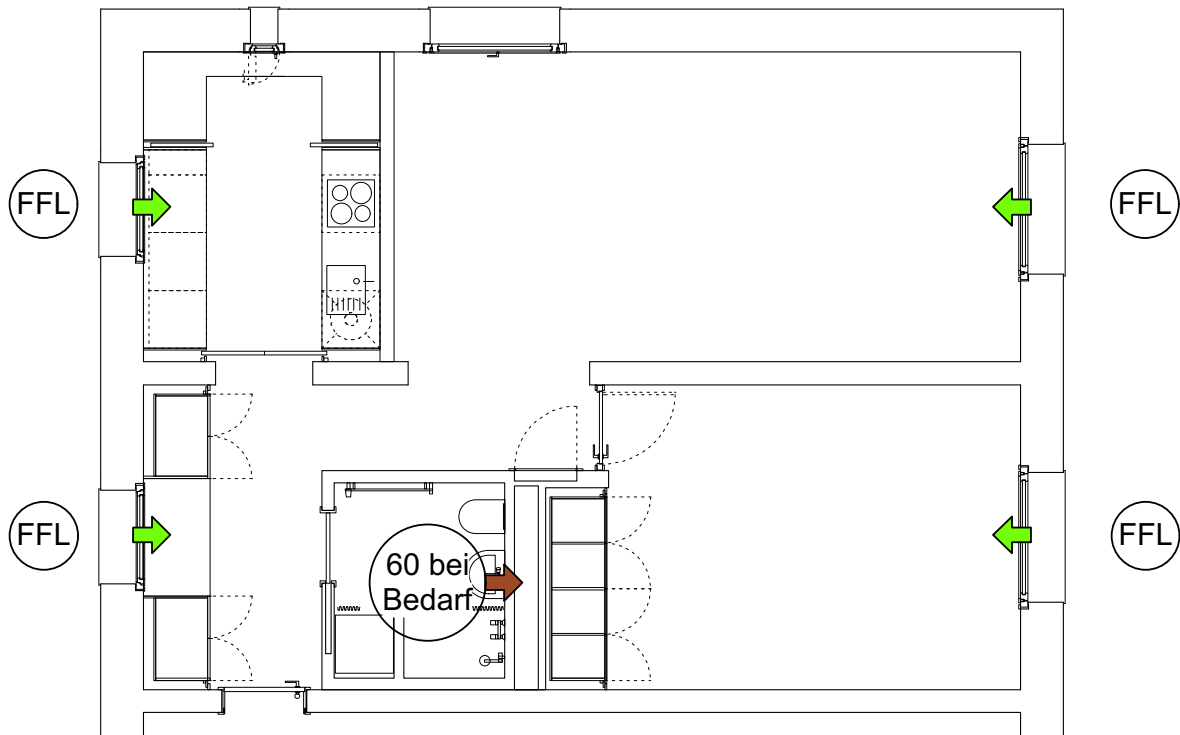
, Grundriss Schema Szenario A: Fensterlüftung / Badabluft präsentgeführt, Quelle: Florian Nagler Architekten / Tilmann Jarmer, TU München [Jarmer 2023]
